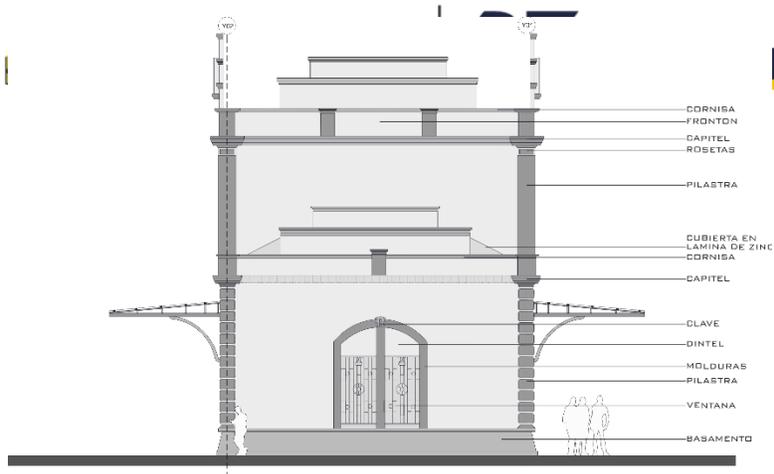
Alzado lateral izquierdo, Estación del ferrocarril Sur.
